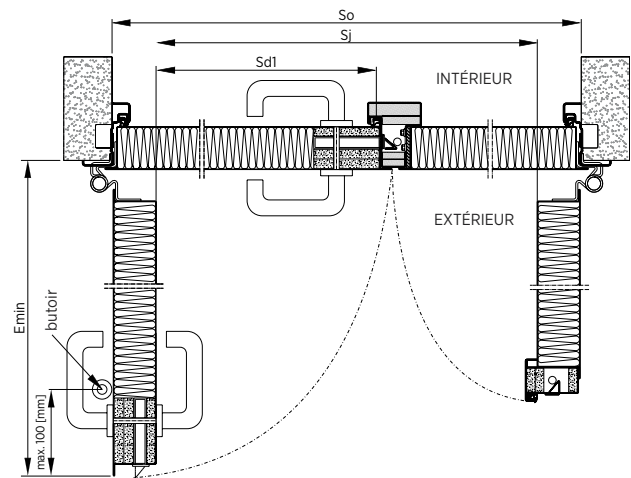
Montage au bâti angulaire d'un bloc-porte à deux battants - coupe horizontale
